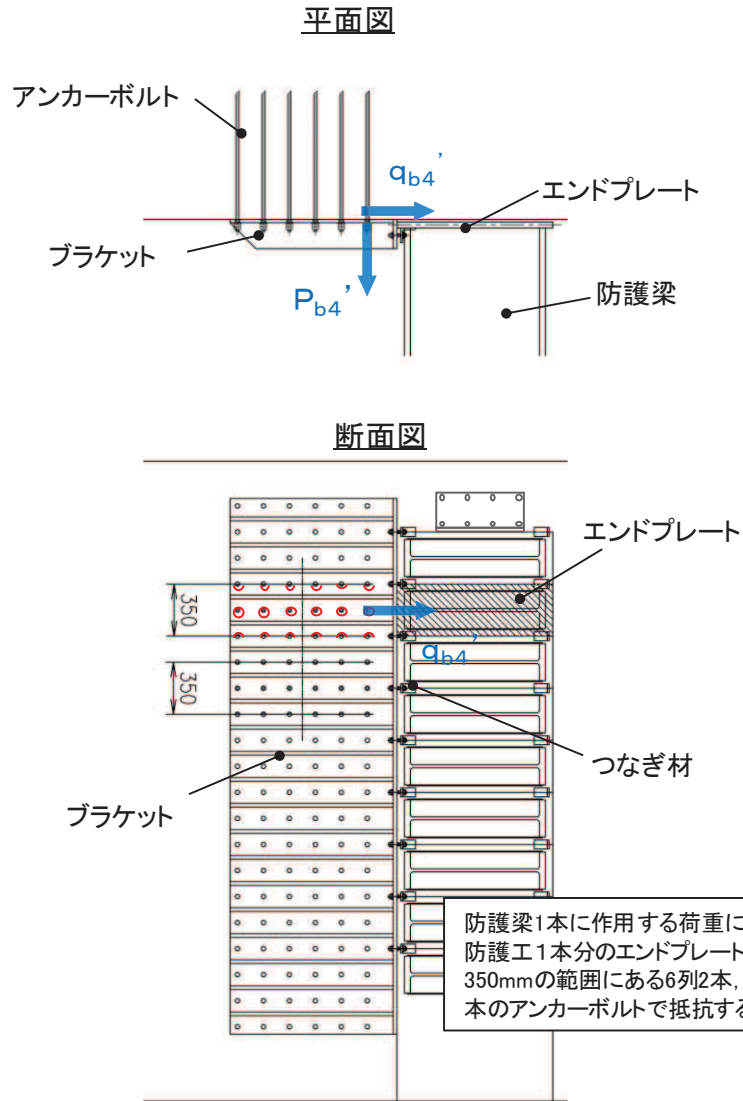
アンカーボルトの引き波時の検討イメージ図
